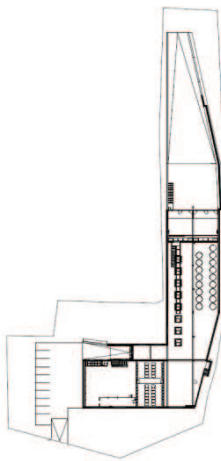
Grundrissplan Weingut Hillinger
